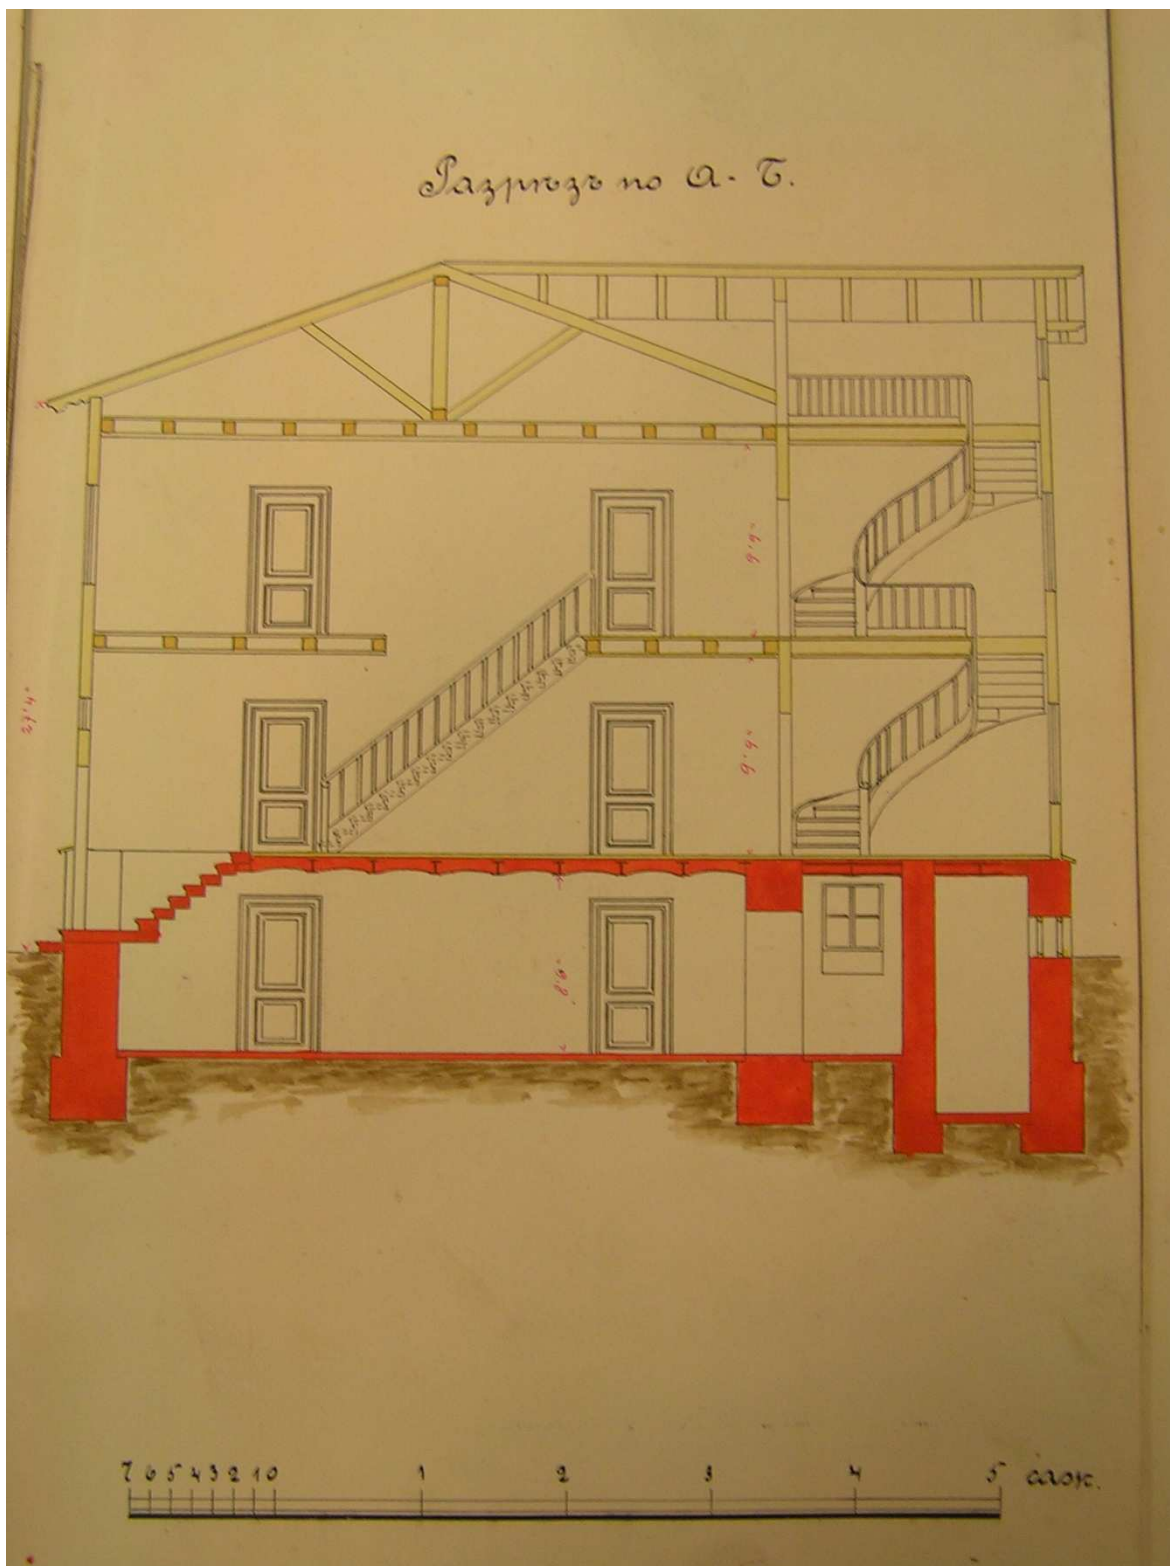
hoone lõige, 1906. a – foto arhiividokumendist
